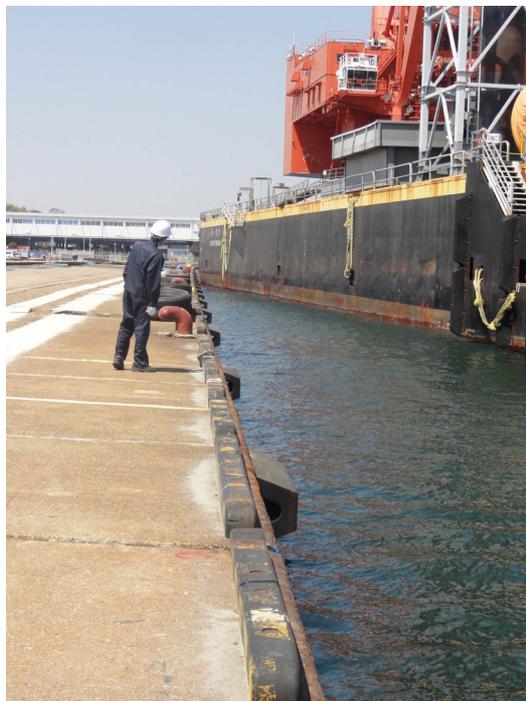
No.9 日立港区_第4埠頭地区 4-C 岸壁 (-7.5m) の被災状況
